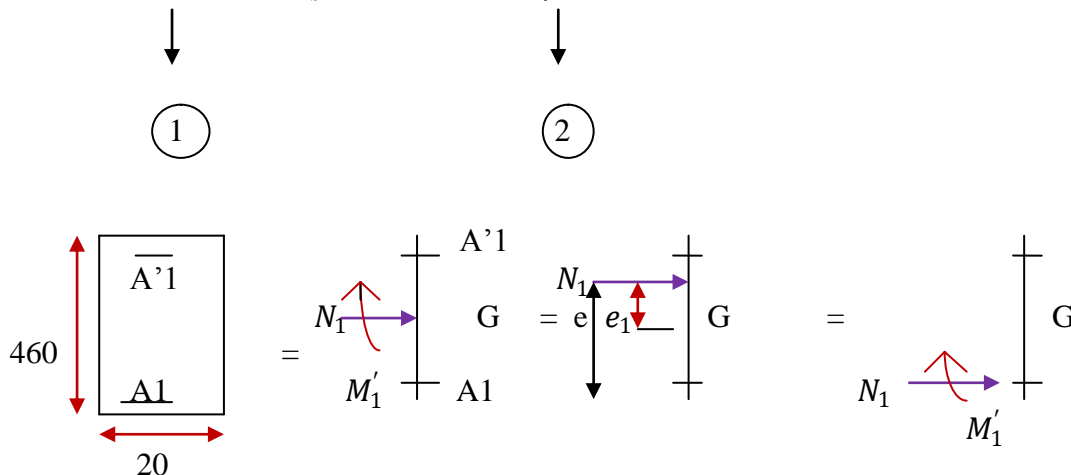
position de N_1 , M'_1 et M_1 sur la section transversale .
